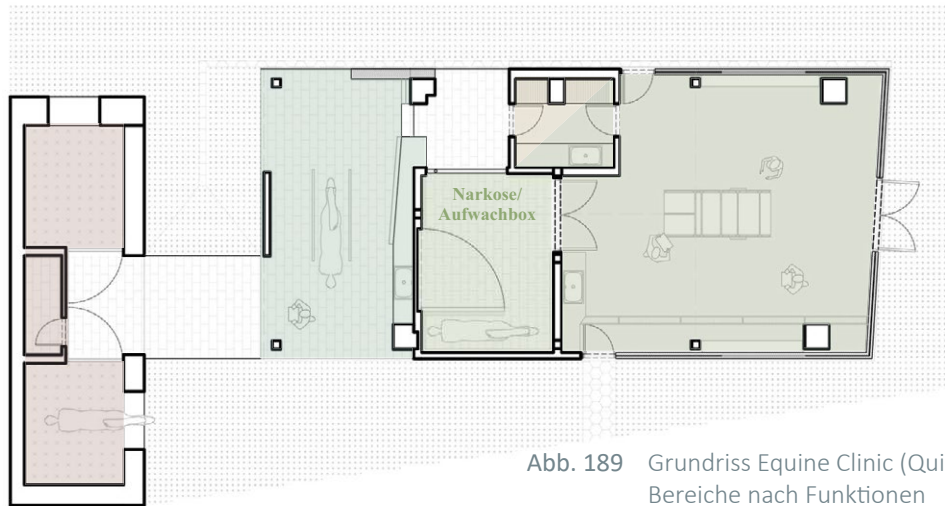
Grundriss Equine Clinic (Quito)
